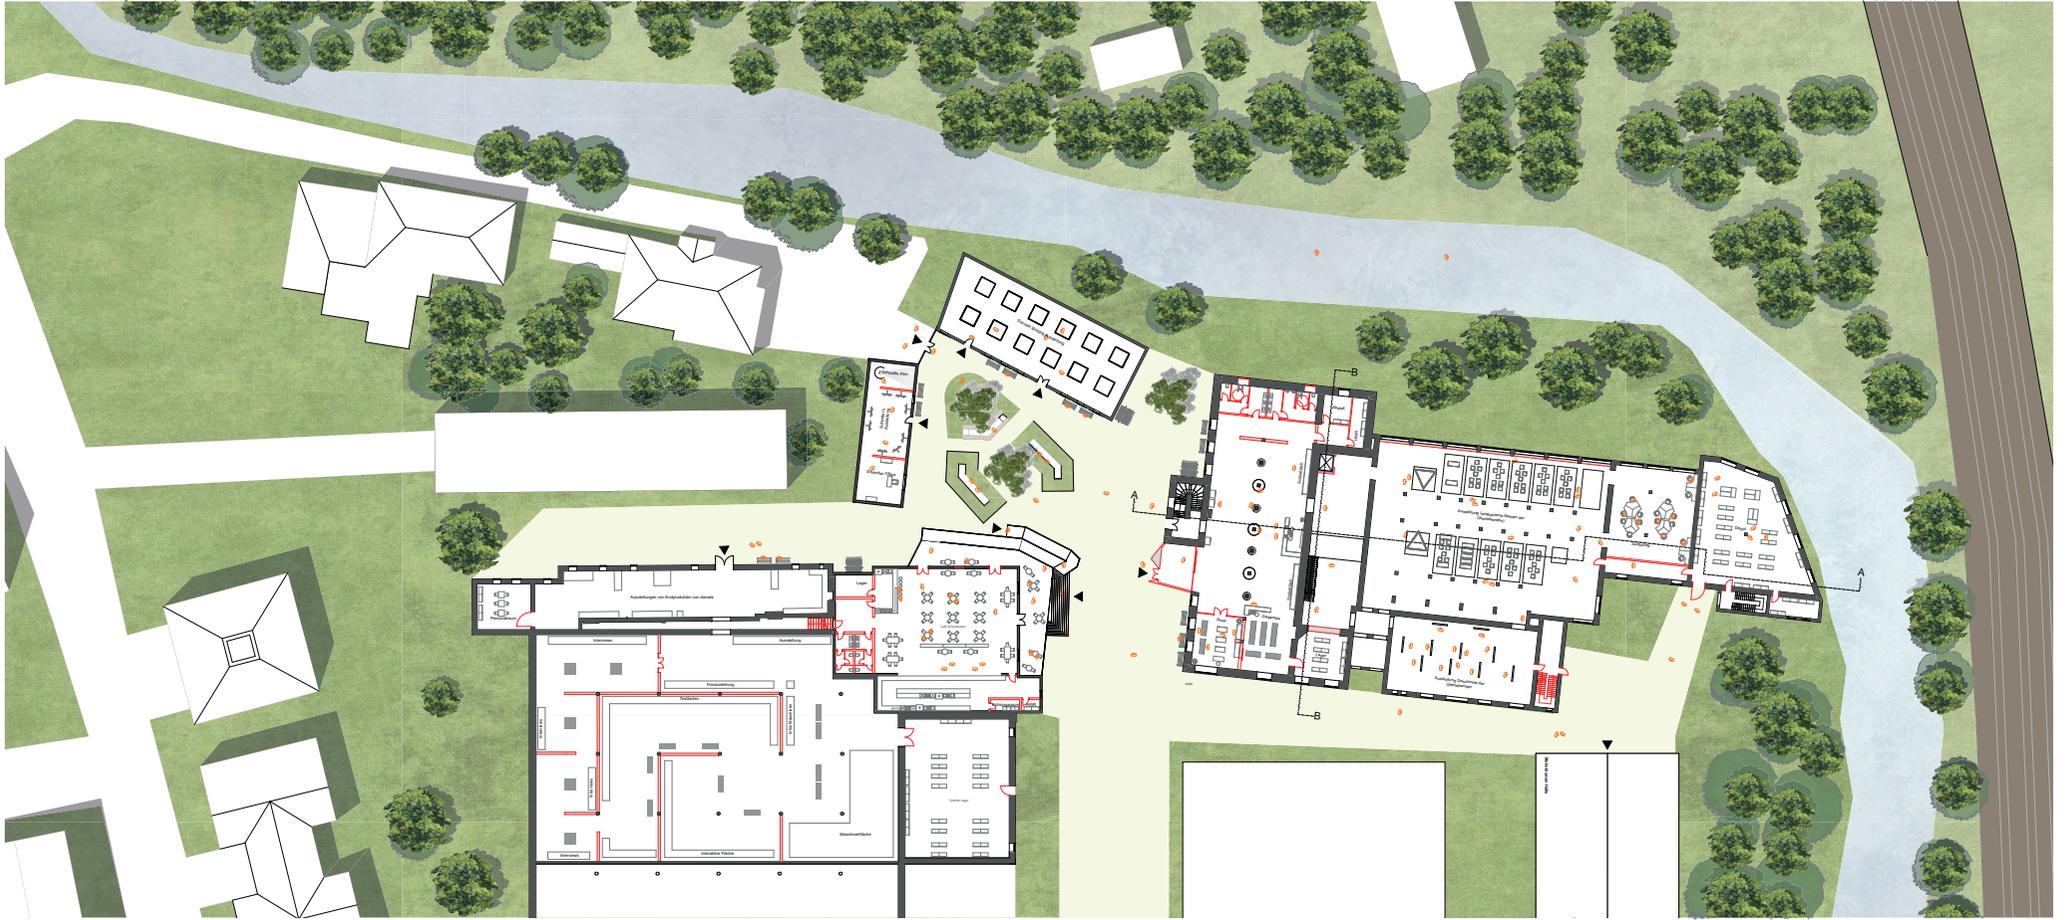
Lageplan Grundriss EG M 1 : 1.000
